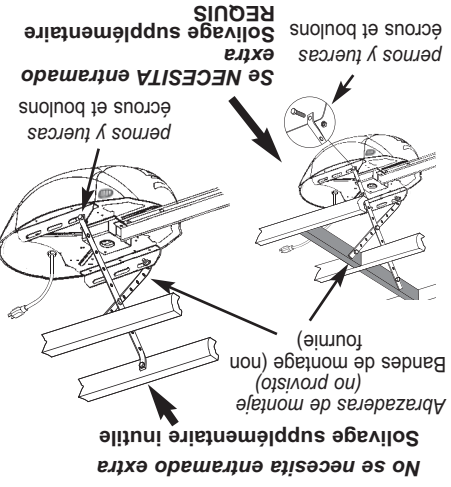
Montaje de la caja de control. Montaje de la tête motorisée.
